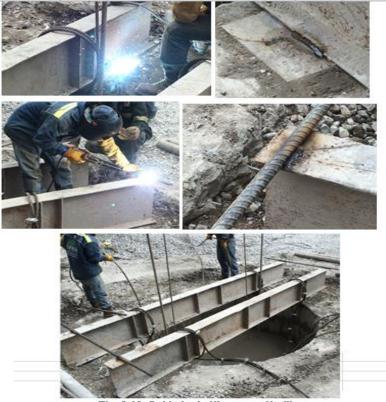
, Soldado de Viguetas y Varillas
